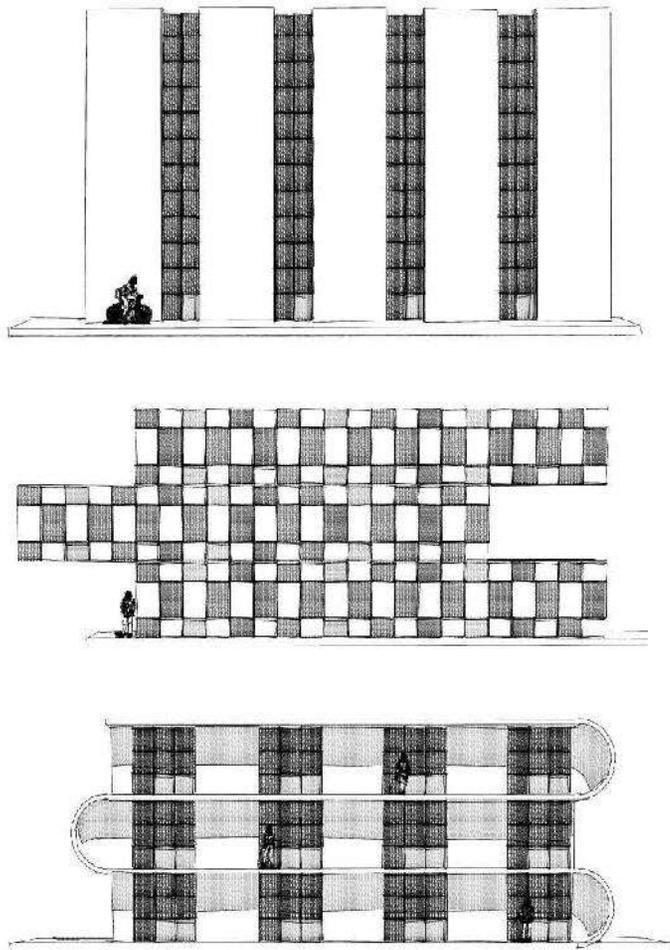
Propuestas de fachadas y acristalamientos en edificio principal.
